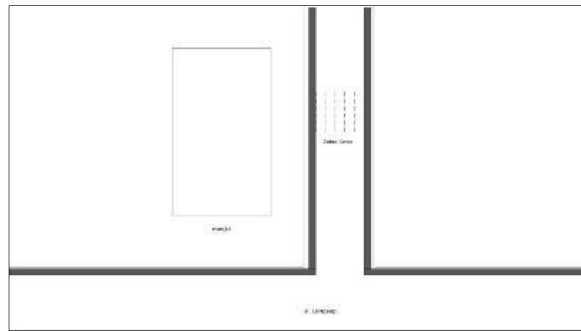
On Street Parking dan Perencanaan Lay Out.
